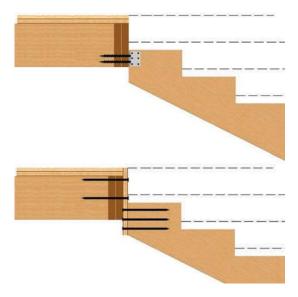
28: Anclaje superior de la zanca a la estructura de entrepiso por medio de conectores metálicos o unión clavada con contrachapado.
